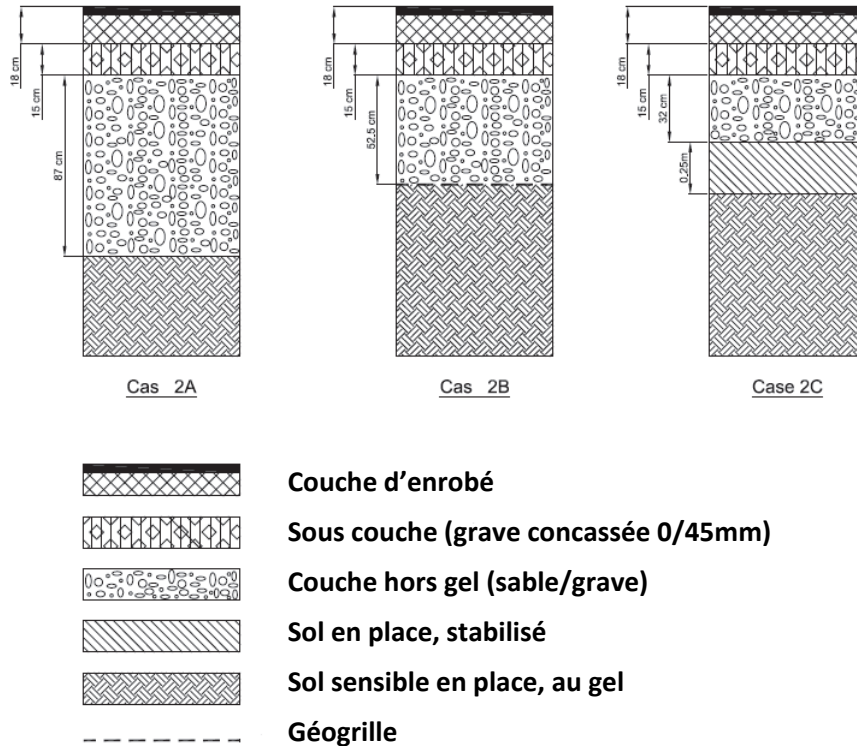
Profils d'une route standard (cas 2A, à gauche), d'une route renforcée par géogrille (cas 2B, au centre) et d'une route sur sol traité chaux/ciment (cas 2C, droite).
